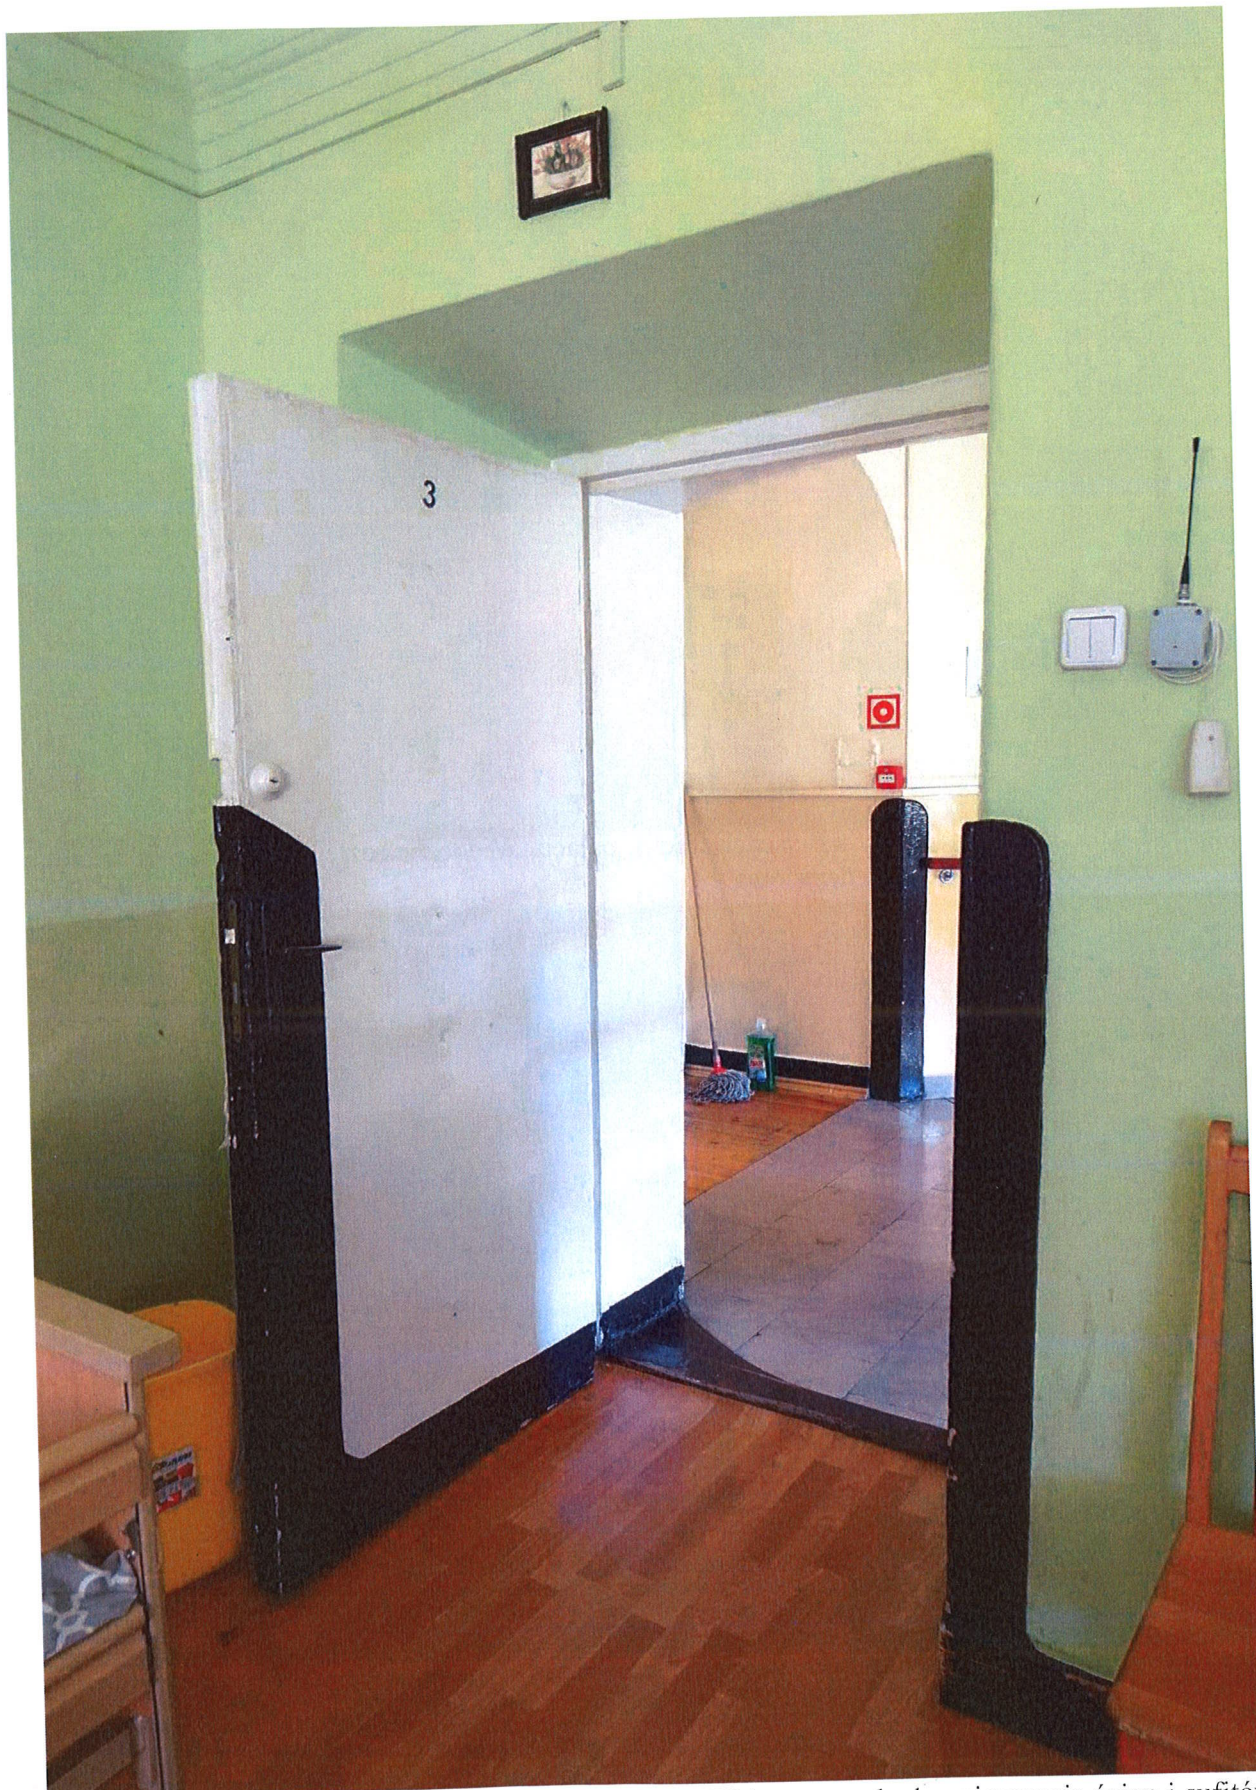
Pałac Badenich w Bejscach. Piętro pałacu. Widoczne rozległe zniszczenia ścian i sufitów oraz współczesna stolarka drzwiowa.
